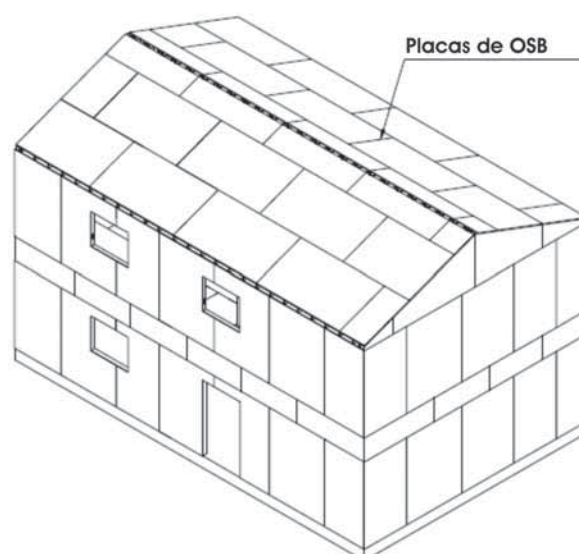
Assentamento das placas de OSB na estrutura. (Adaptado de ConsulSteel)
